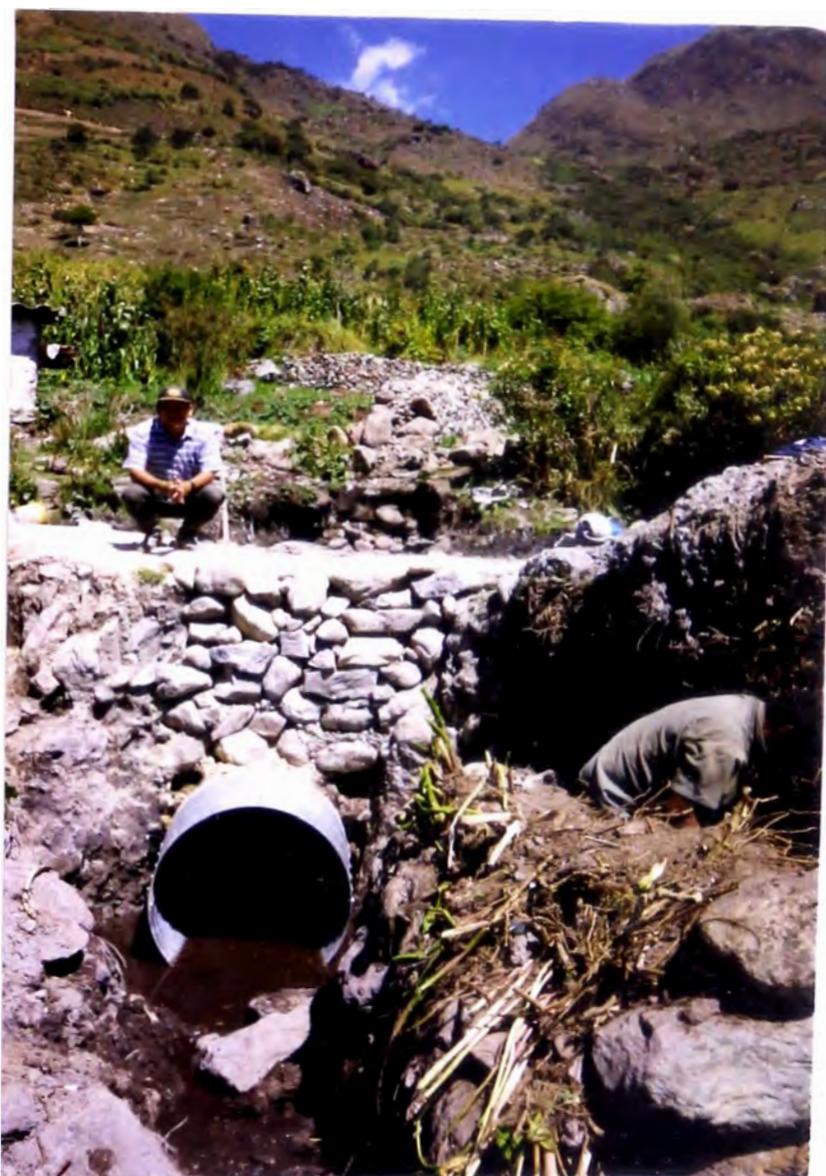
ALCANTARILLA ANTERIOR, OBSERVESE EL MATERIAL QUE PASA POR LA ALCANTARILLA (GREDA)
